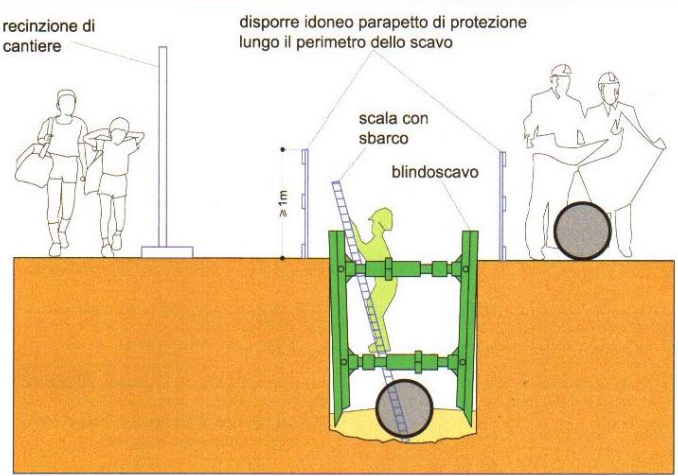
Delimitazione del ciglio scavo con parapetti alti almeno 1,00 m.
